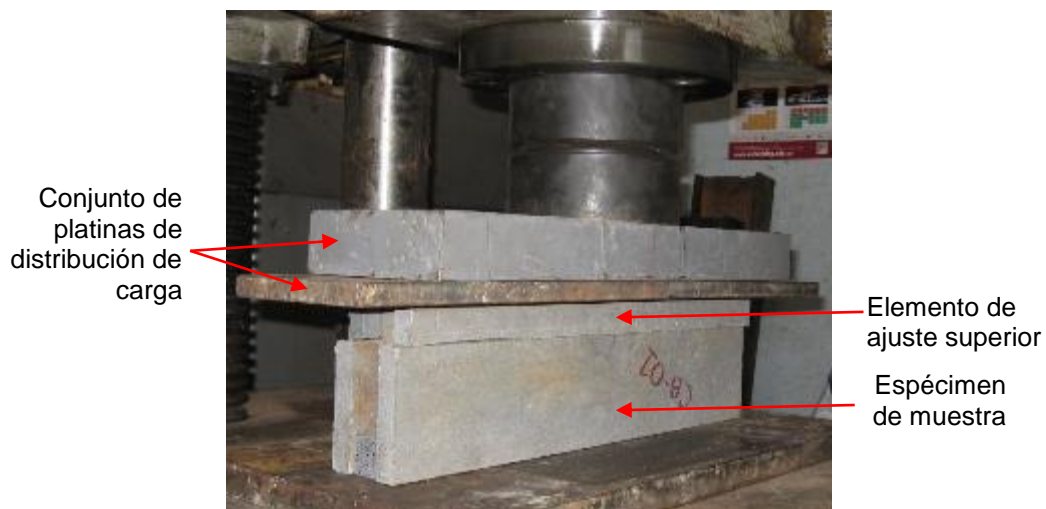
Montaje ensayo a compresión en bloques Brickarp® vista perfil. Fuente: Autor
